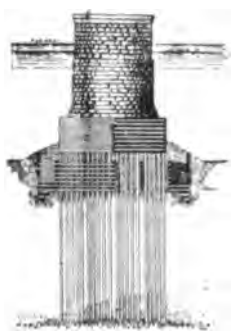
Fondation de la pile centrale de la travée tournante du Pont de New-London.
